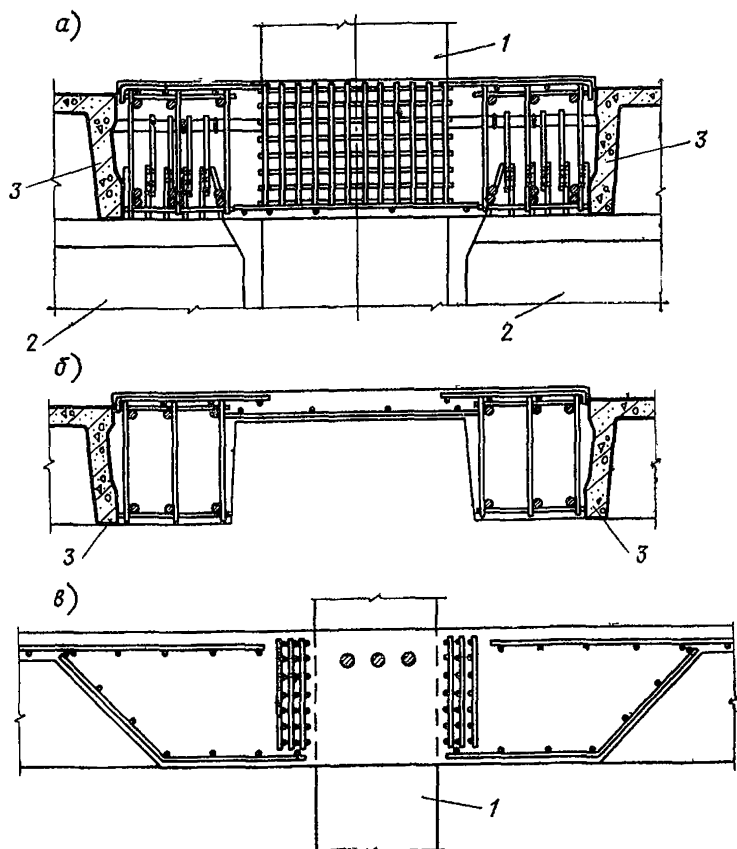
Армирование продольного монолитного железобетонного ригеля перекрытия
